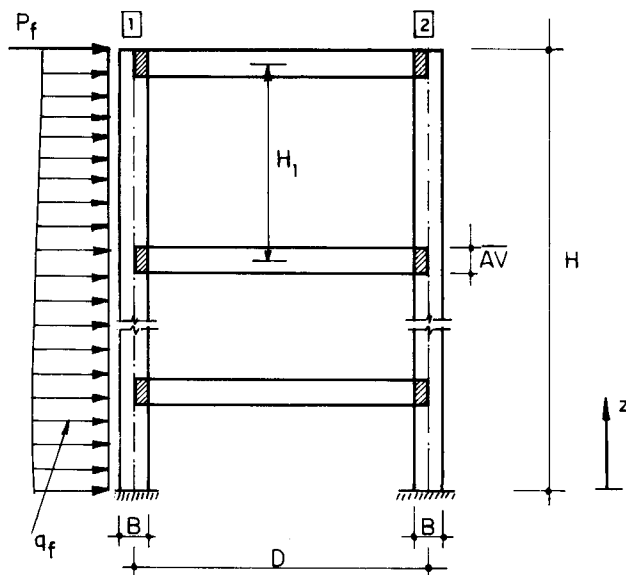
Painel com dois pilares de pórtico unidos por vigas
